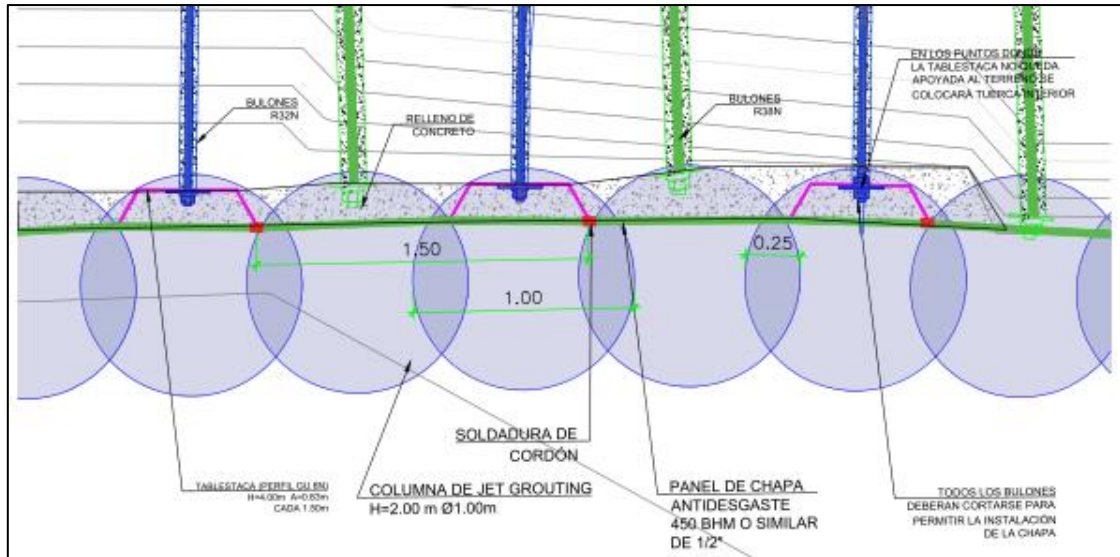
Detalle en planta de la defensa proyectada. Fuente: Elaboración propia.
